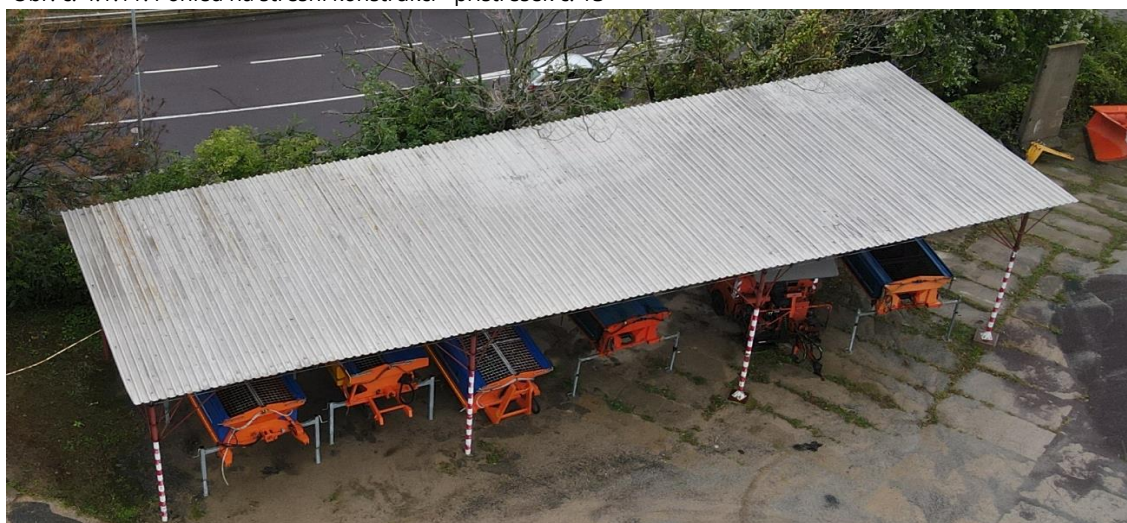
Pohled na střešní konstrukci - budova č. 7
